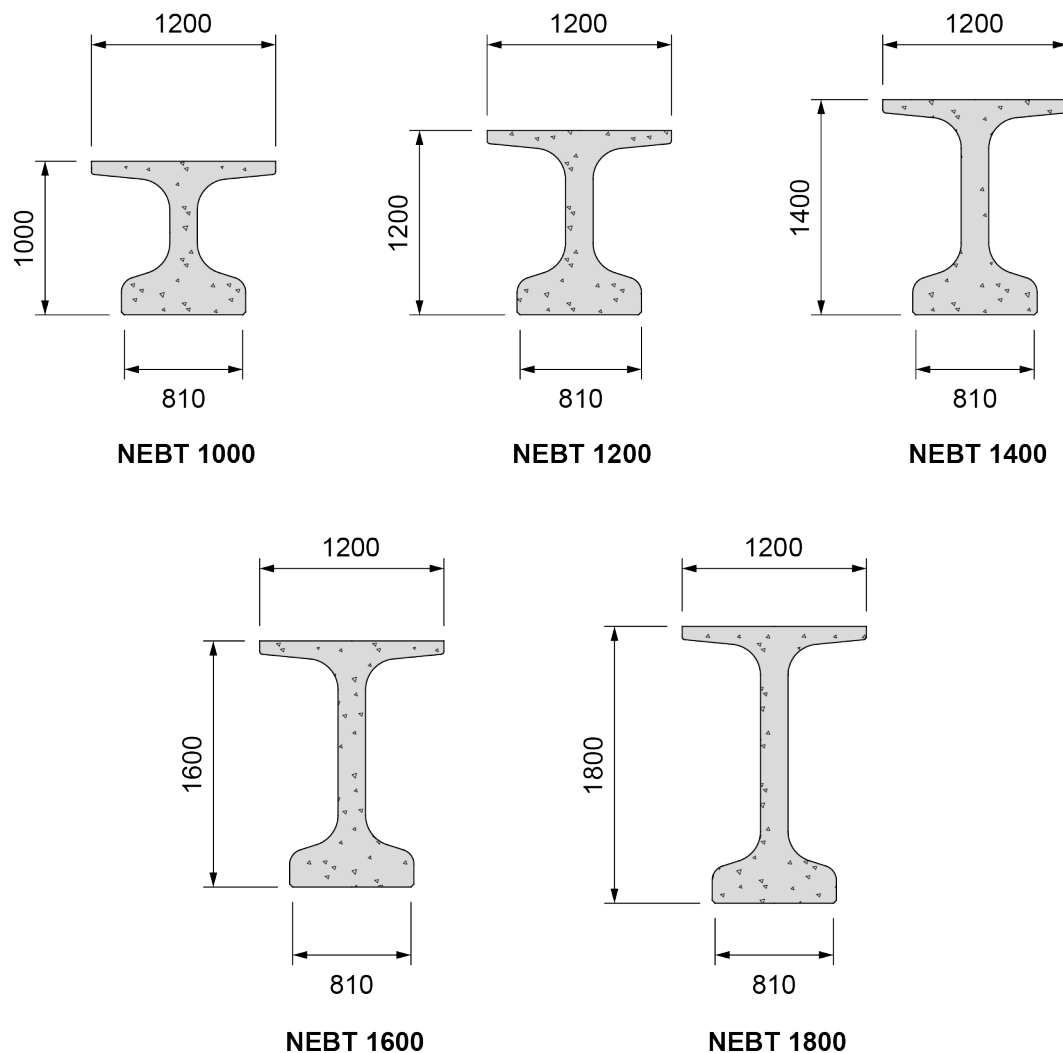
Poutres en béton précontraint préfabriqué de type NEBT
